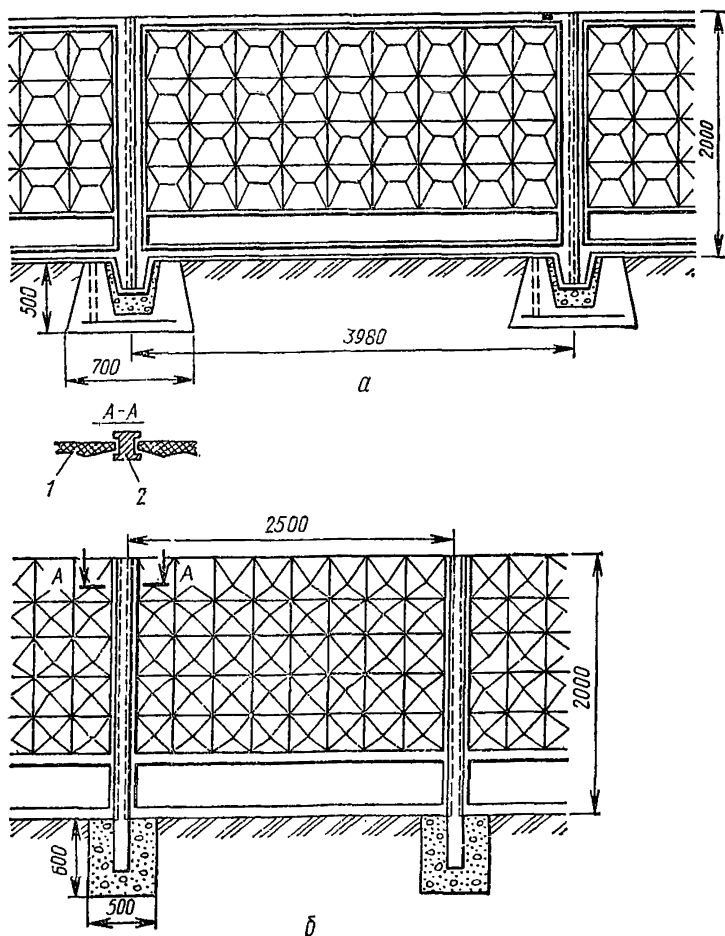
Наружное ограждение парка из сборных железобетонных плит (варианты):
